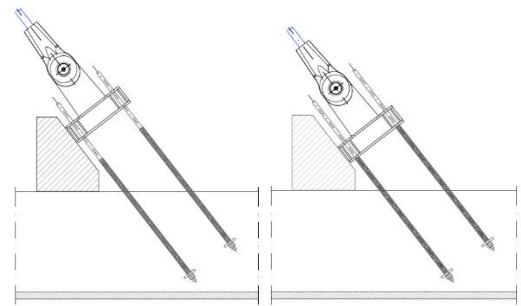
Desplazamiento del anclaje de retenida durante el tesado.
